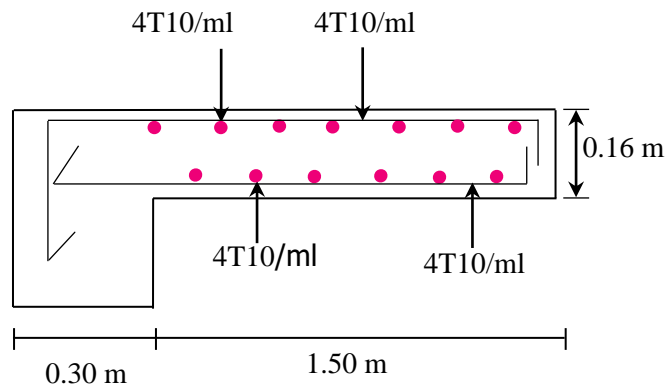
Ferrailage du balcon encastré sur deux coté.
